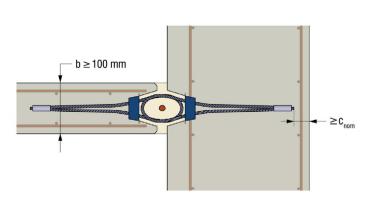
Wand – Wand – T-Verbindung - Regeldetail (vertiefter Einbau)
